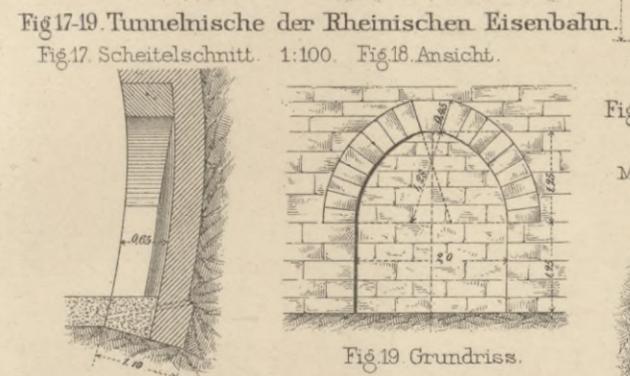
Tunnelnische der Rheinischen Eisenbahn. Fig. 17. Scheitelschnitt. 1:100. Fig. 18. Ansicht. Fig. 19. Grundriss.
